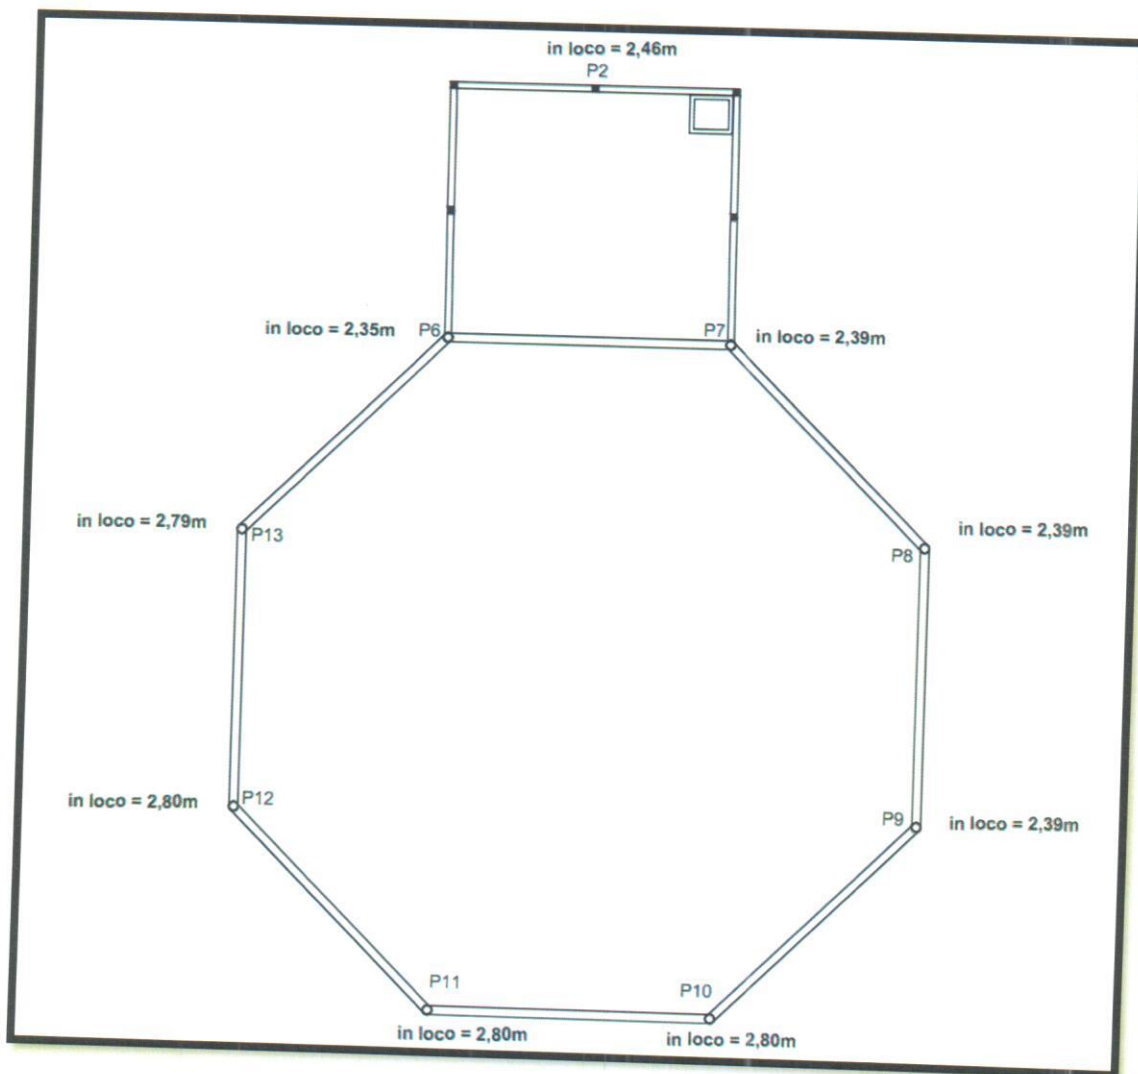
Altura dos pilares verificadas in loco descontando o lastro existente.
